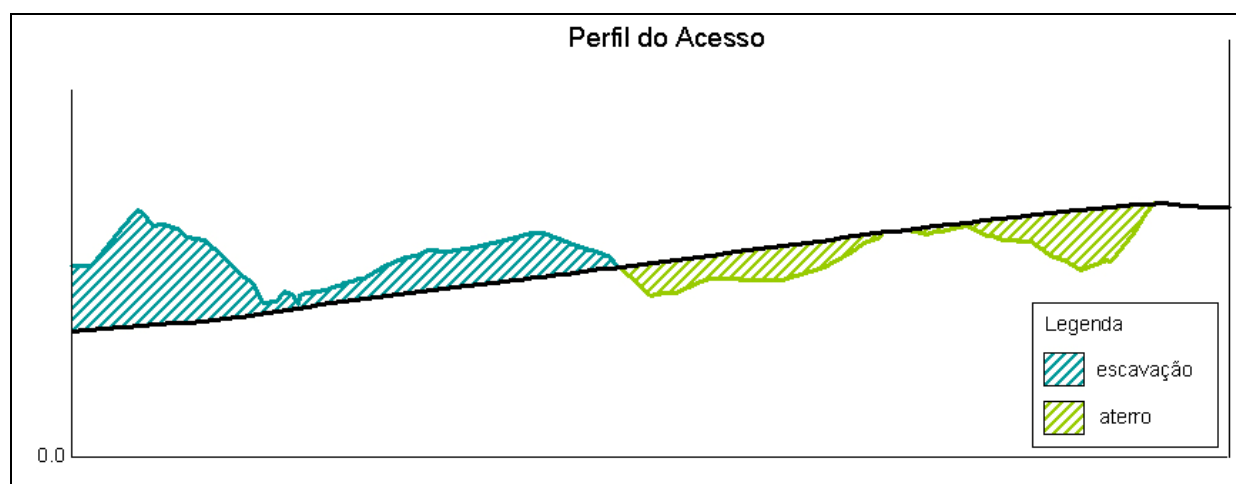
Perfil do Acesso às Instalações Aquícolas
